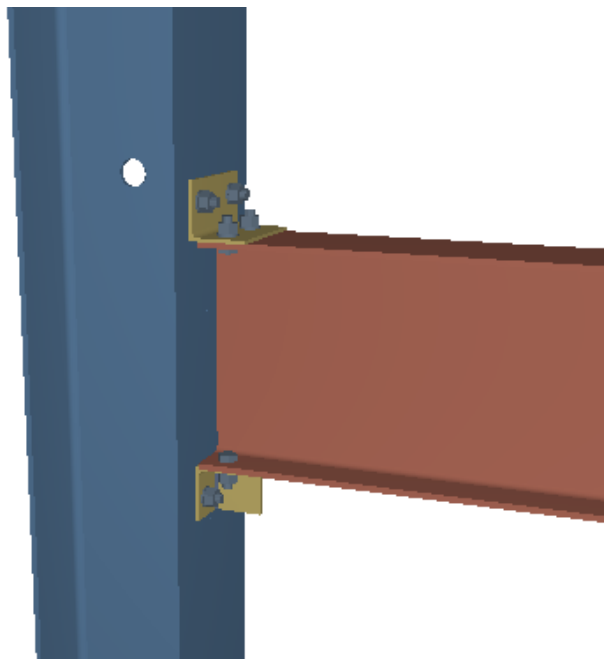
Dupla Cantoneira de Assento em conexões pilar-viga
